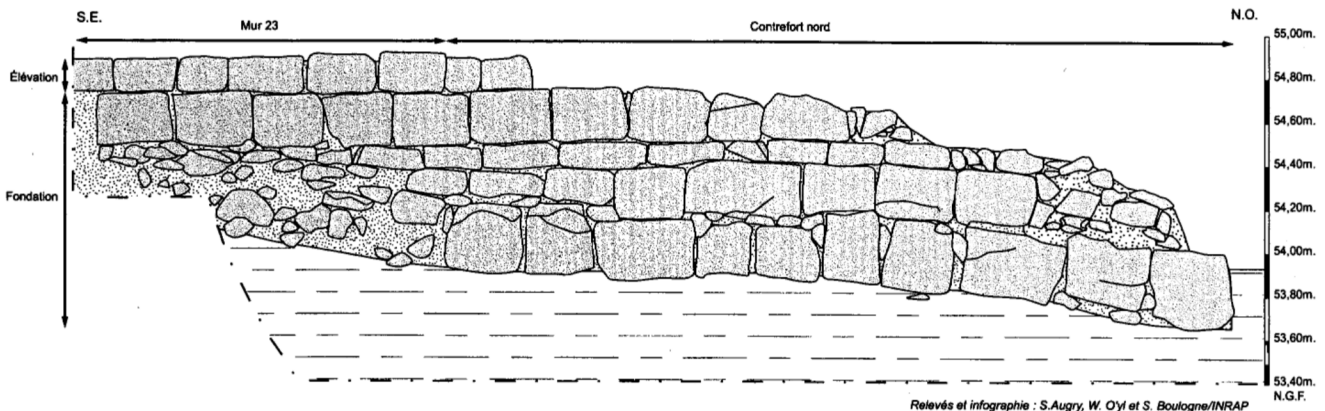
Coupe 31, mur 23 et contrefort nord.
